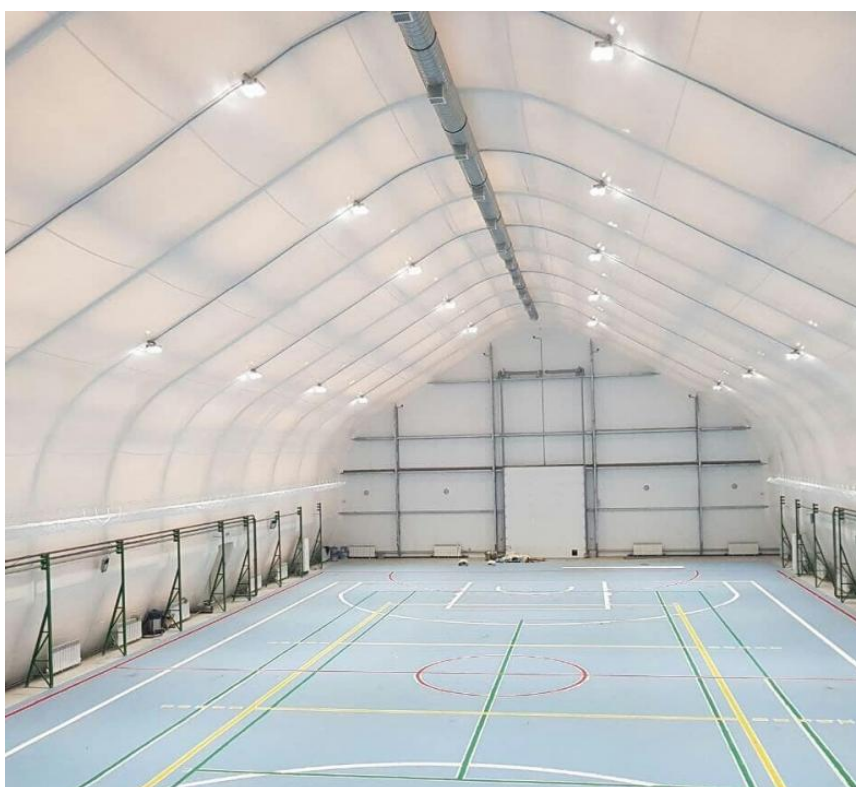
Каркасно-тентовое покрытие спортивной площадки
